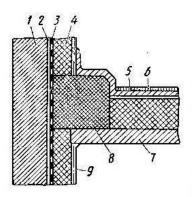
Примыкание междуэтажных перекрытий к наружным стенам:
